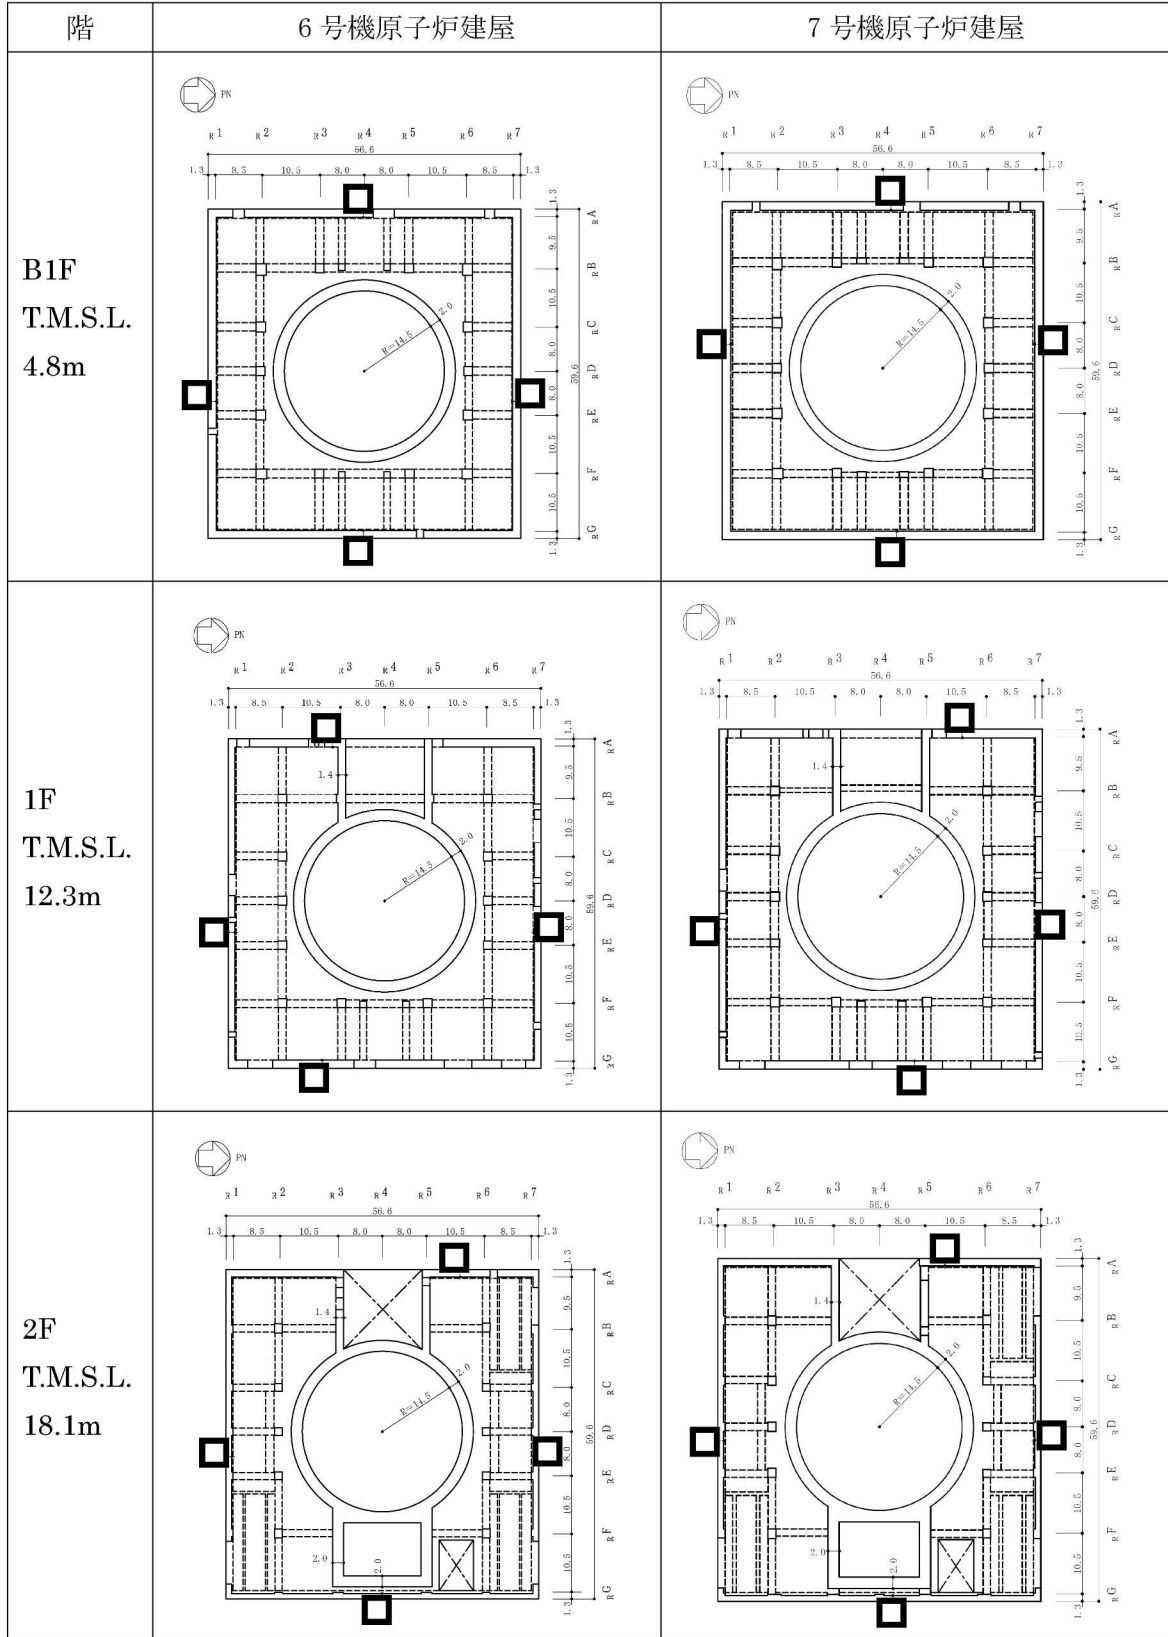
6号機原子炉建屋及び7号機原子炉建屋の概略平面図(3/4)(単位:m)
